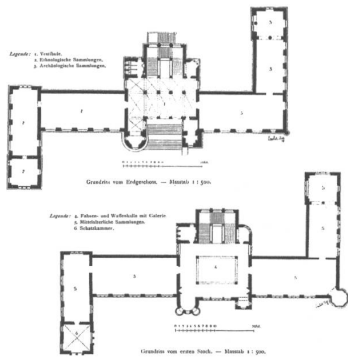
Bern, Historisches Museum: Grundrisse Erdgeschoss und I. Stock.
